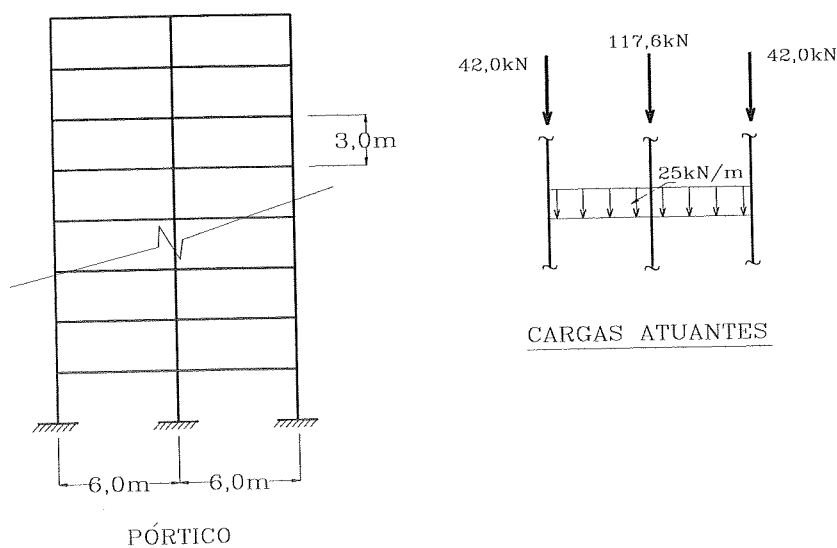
Pórtico Plano Analisado e Cargas Atuantes
